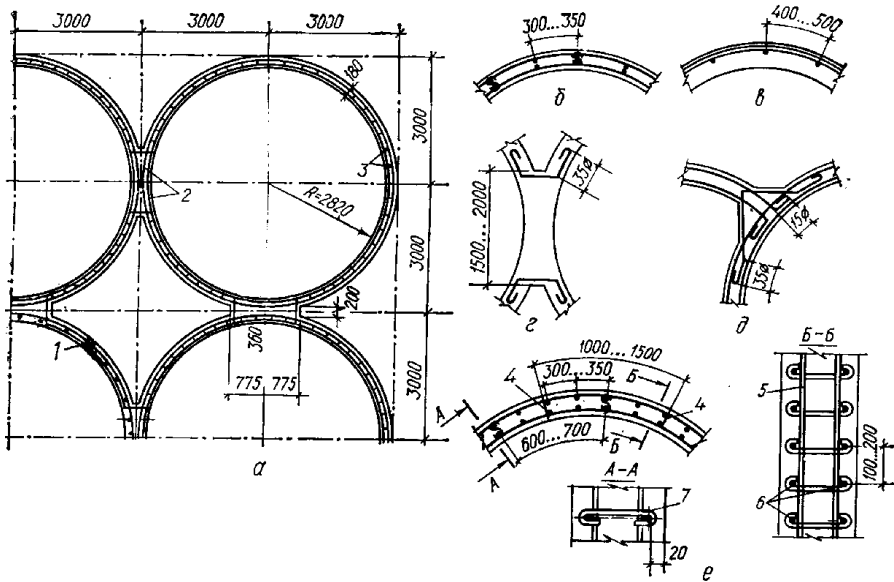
Армування круглих монолітних силосів:  $a$  – план і загальний вигляд;  $б$  – подвійне армування стінок;  $в$  – одиничне армування стінок;  $г$ ,  $д$  – додаткове армування спряжень стінок;  $е$  – деталь армування силосу подвійною арматурою; 1 – вертикальна арматура з кроком 400...450 мм; 2 – те ж, з кроком 200 мм; 3 – те ж, з кроком 300...350 мм; 4 – зварний каркас; 5 – вертикальна арматура; 6 – кільцева арматура; 7 – шпильки
